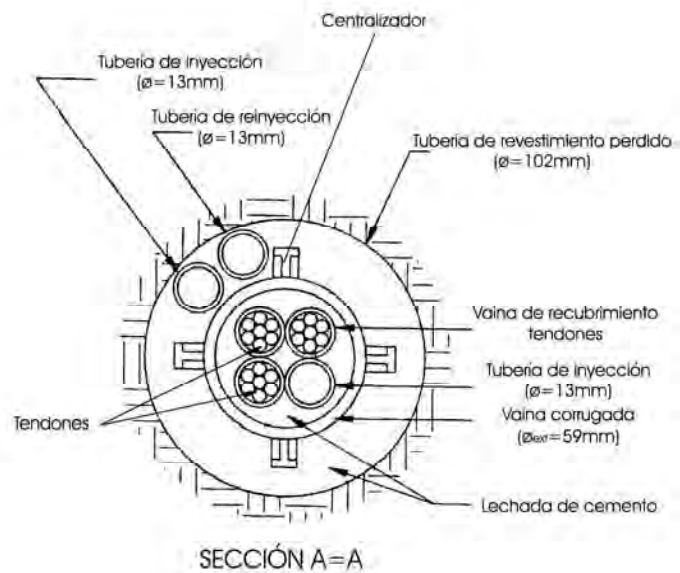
SECCIÓN TRANSVERSAL ANCLAJE EN ZONA LIBRE
